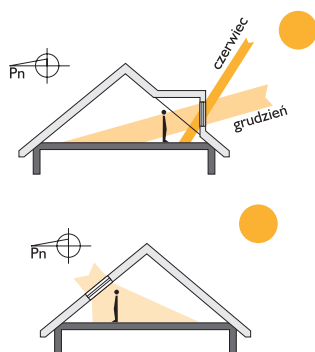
Z reguły montowane są większe okna przy mniejszym kącie nachylenia dachu. Stosując okna dachowe, wprowadzamy do wnętrza więcej światła naturalnego niż w przypadku okien montowanych w lukarnach. Im wyżej zamontowane okno, tym lepsze będzie doświetlenie pomieszczenia.
